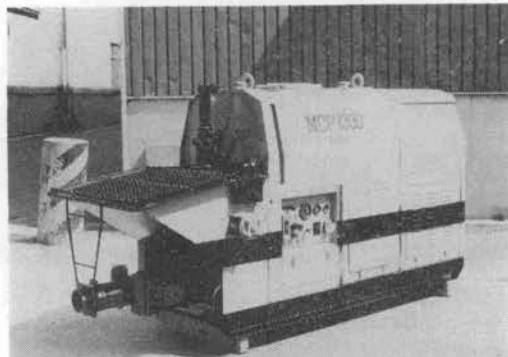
ワキタ MCP 1300 メイホーコンクリートポンプ
